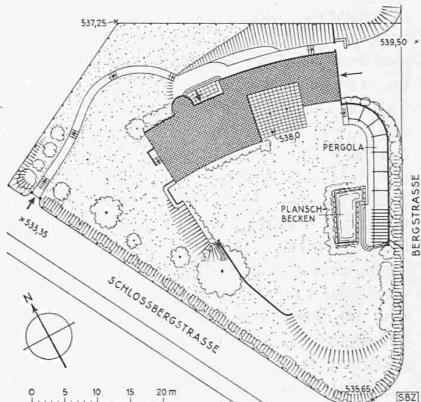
Lageplan Schlossberg-Bergstrasse in Zollikon
